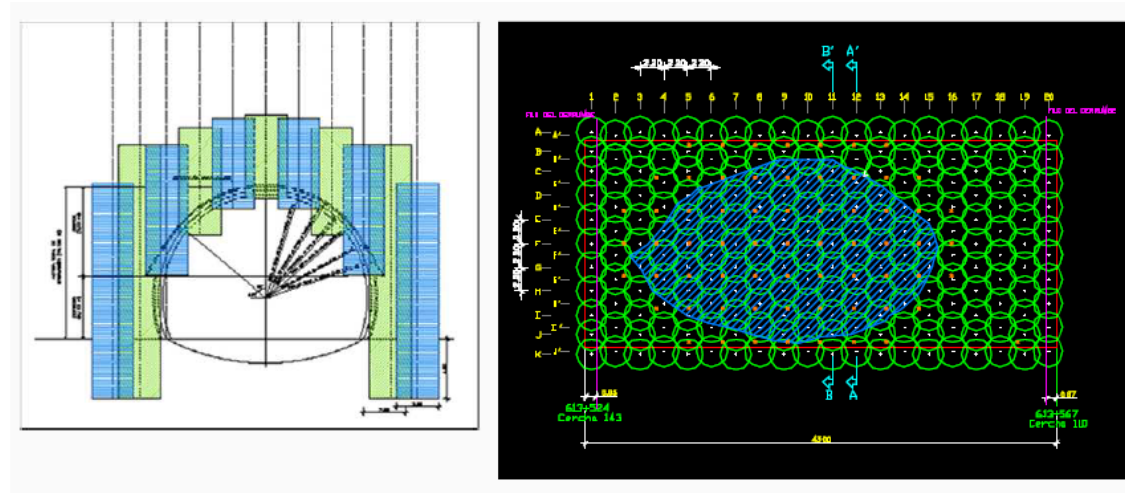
Tratamiento del terreno previo a la ejecución del túnel con columnas de jet-grouting y/o inyecciones.
